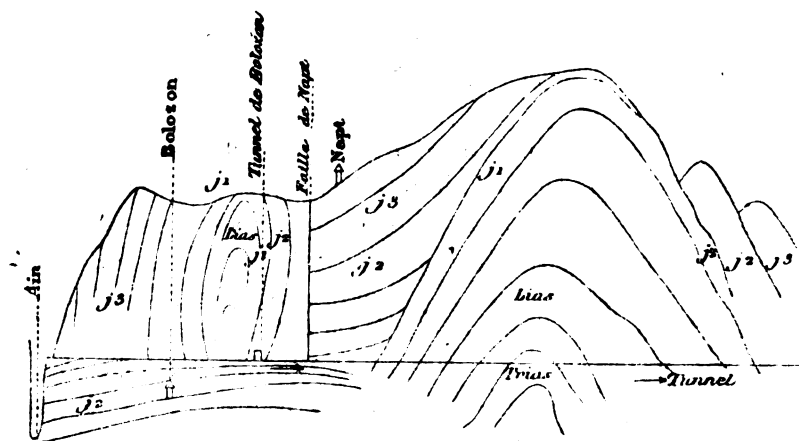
Croquis des couches traversées par le tunnel de Bolozon.
